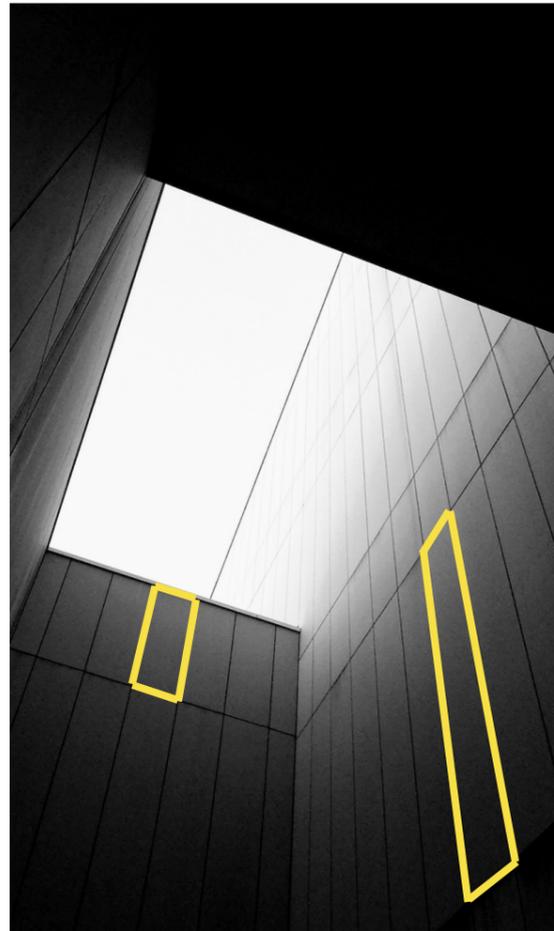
Paneles prefabricados . Fuente: (Jhon Lee, s. f.)
